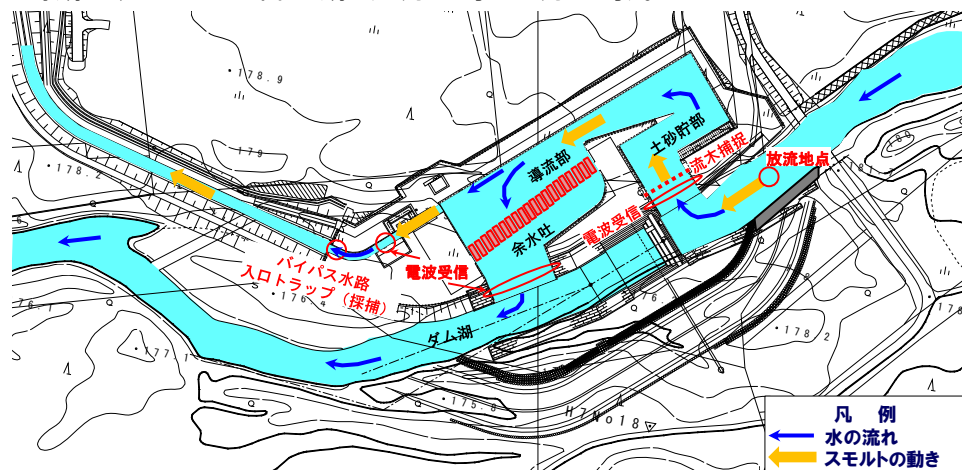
本川との接続箇所におけるスモルト行動調査平面図
